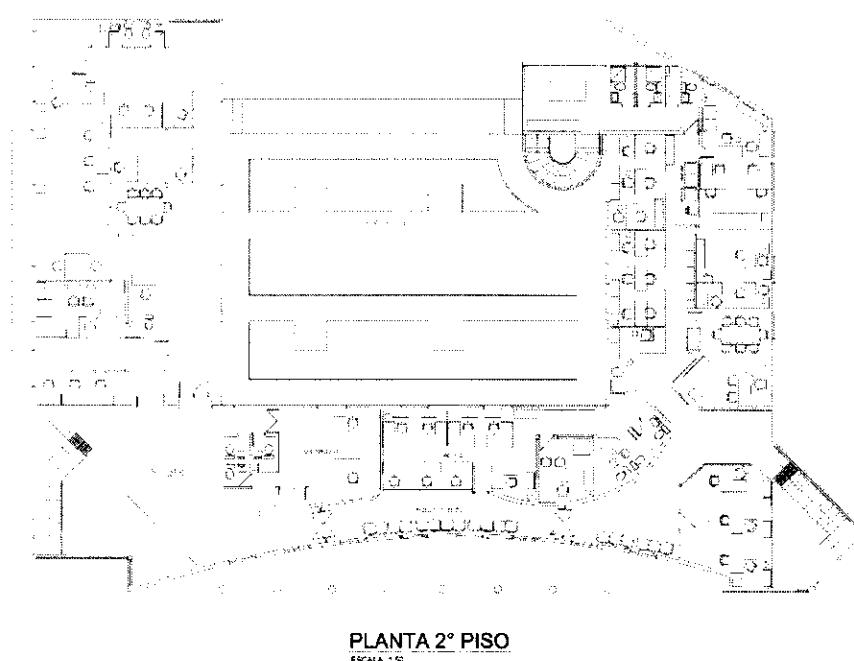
Planimetría Situación Propuesta - Piso 2 Edificio Milenium.
